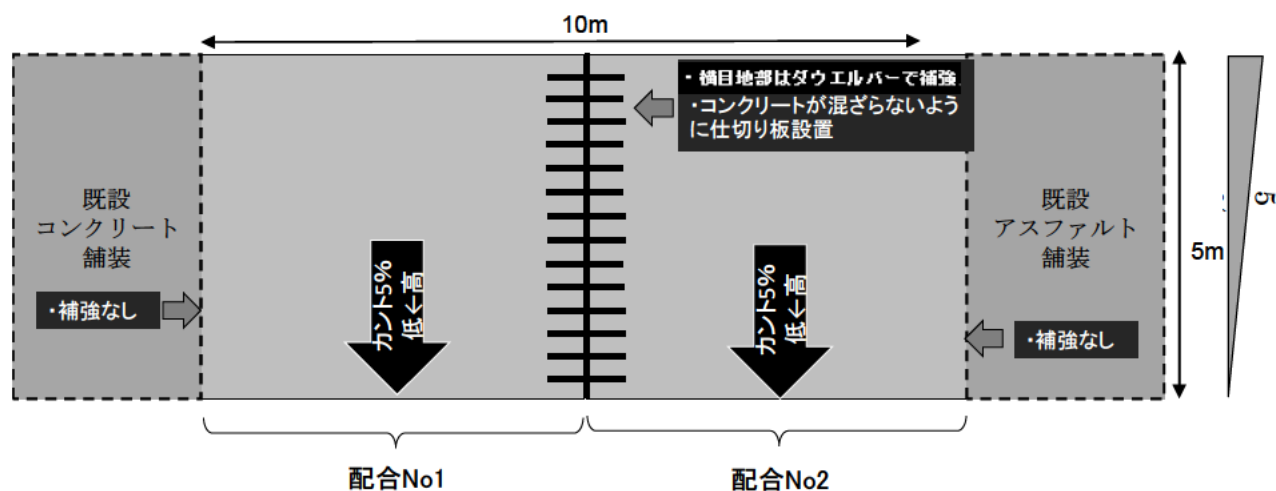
舗装走行実験場に施工した1DAY PAVE試験舗装(平面図)
